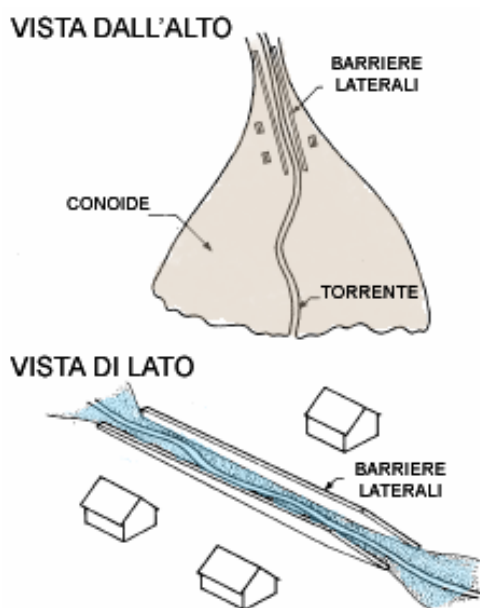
Rappresentazione schematica di un sistema di barriere laterali realizzato all'inizio dell'area di deposizione di una colata -
